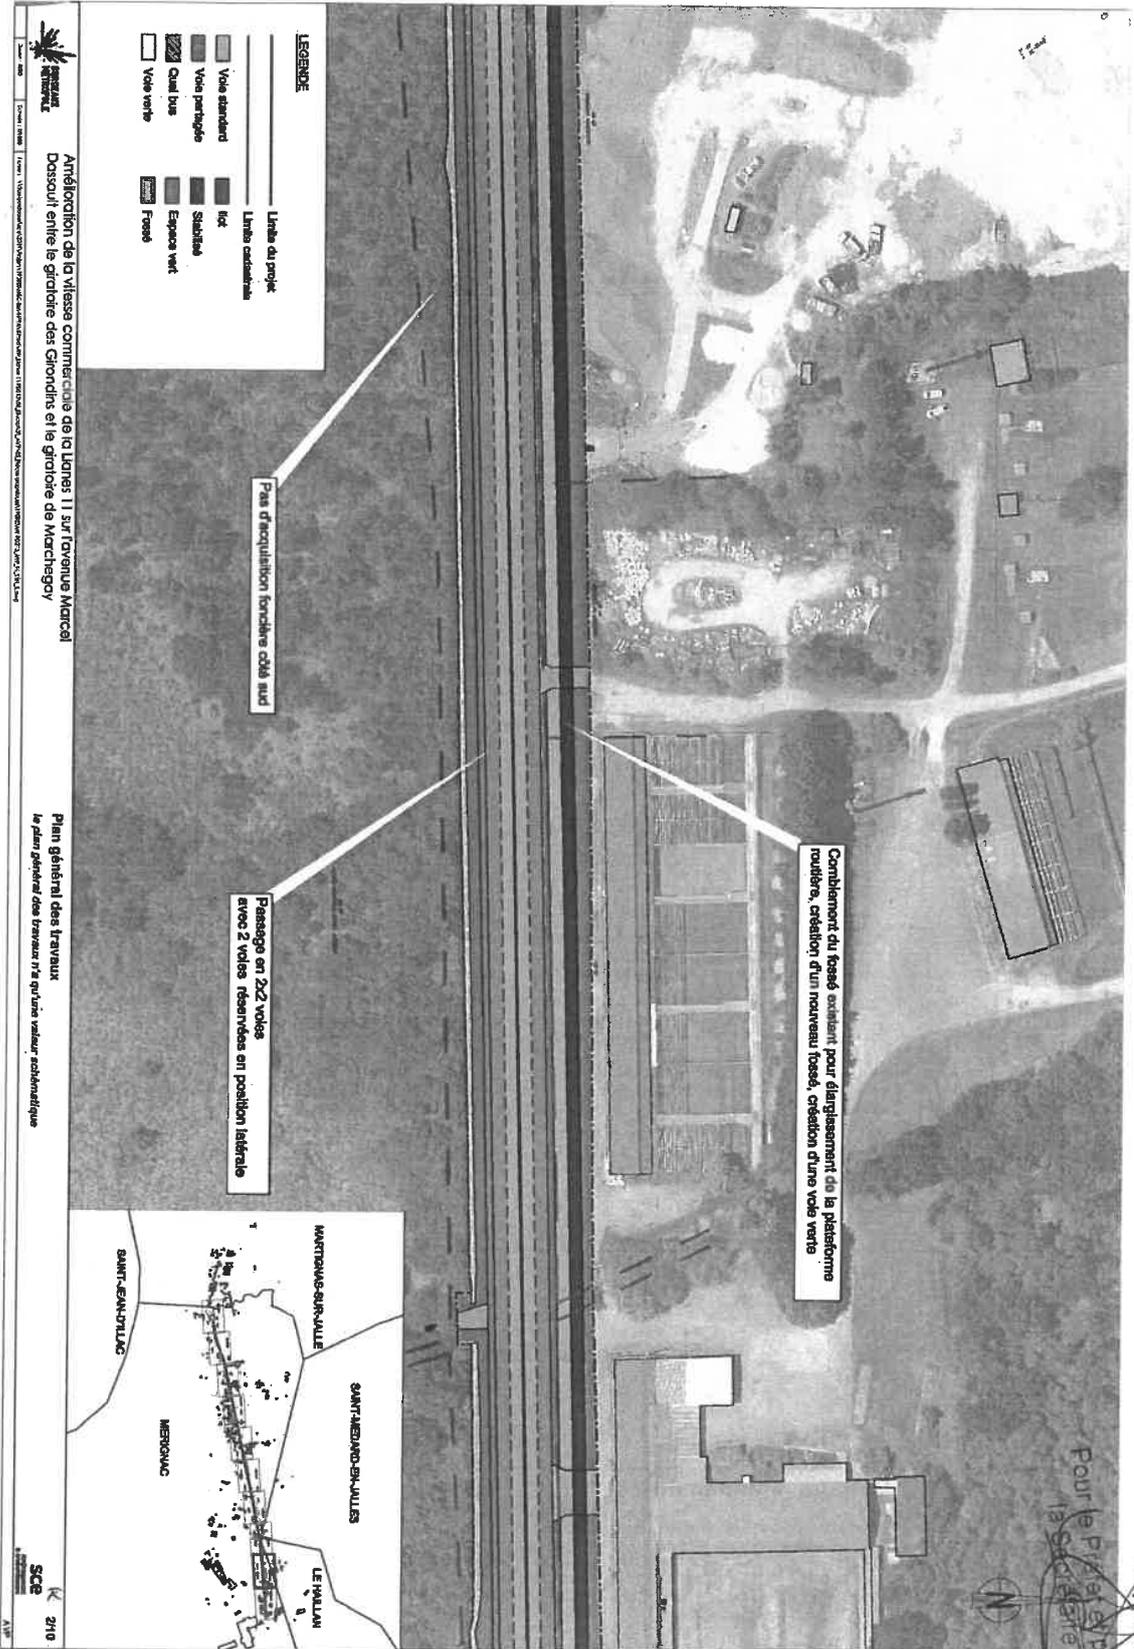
Plan Général des Travaux 8. Source : Bordeaux Métropole
